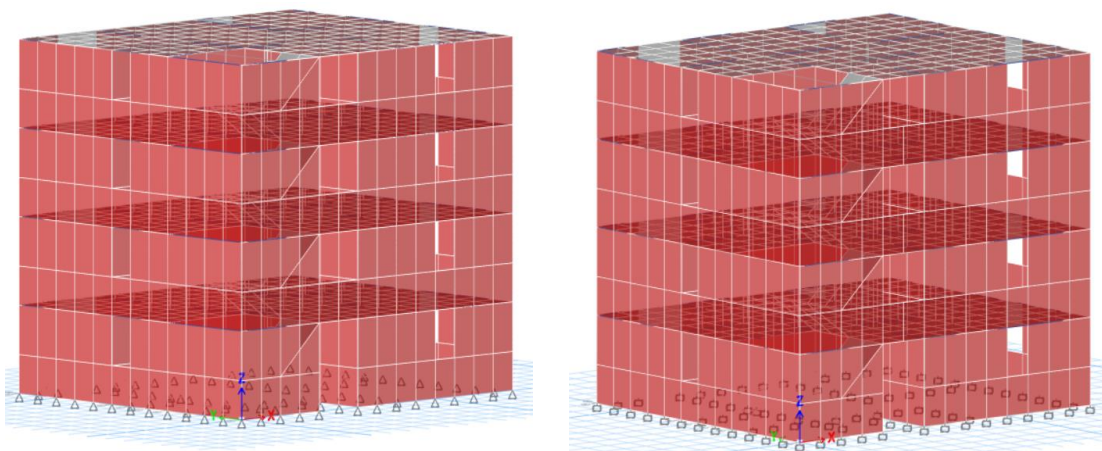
Modelo 2 con discretización media de los muros de mampostería y apoyos articulado (2A) y empotrado (2B) respectivamente.
